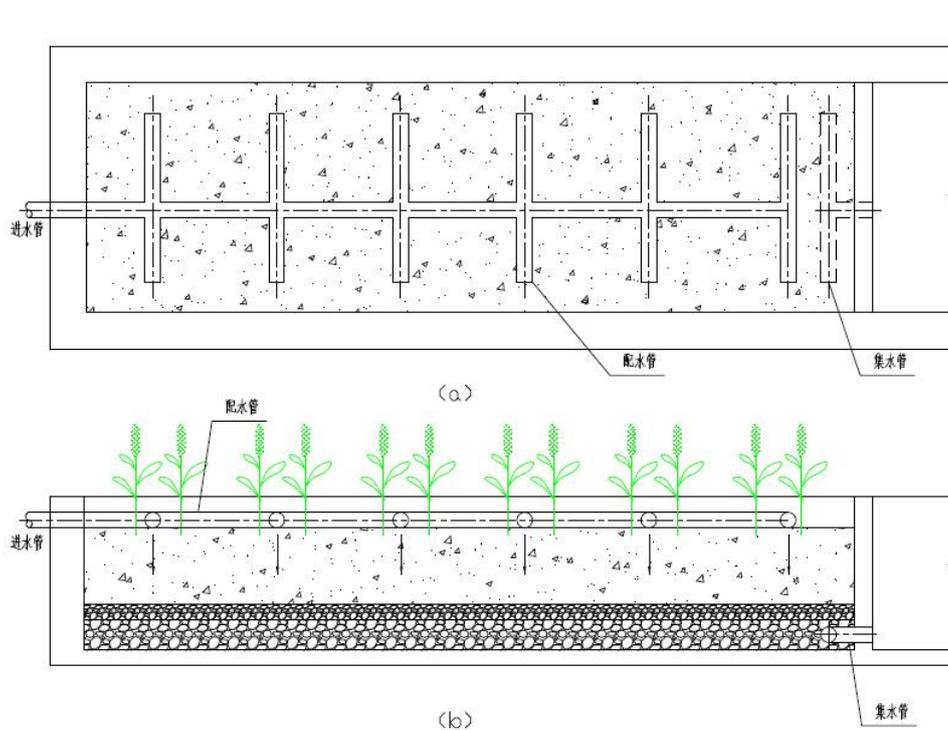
垂直流人工湿地结构简图 (a) 平面图 (b) 剖面图
